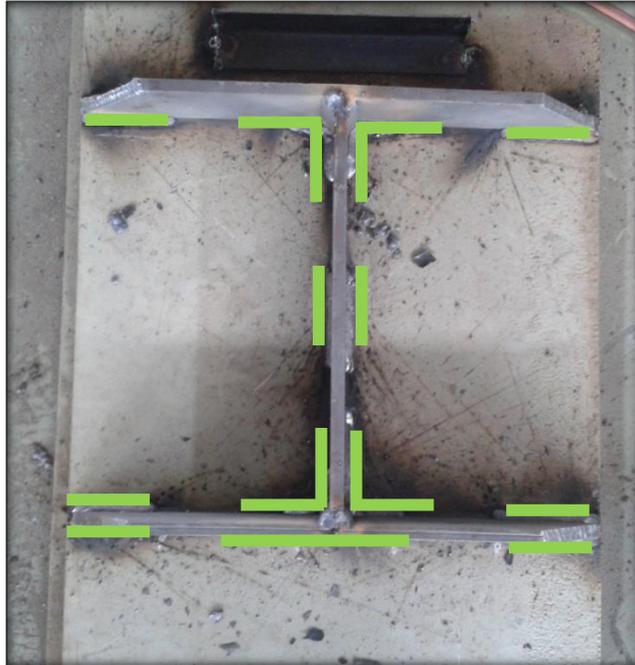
Refuerzo Interno en Unión Viga-Columna con soldadura intermitente
